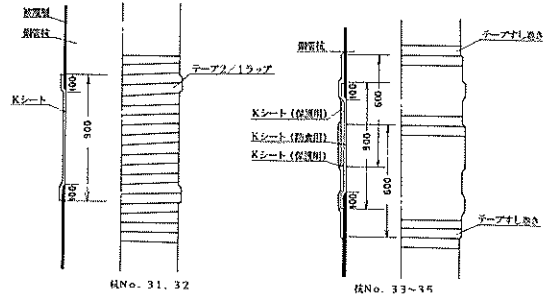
昭和60年補修施工要領図 (ポリエチレン被覆工法)
